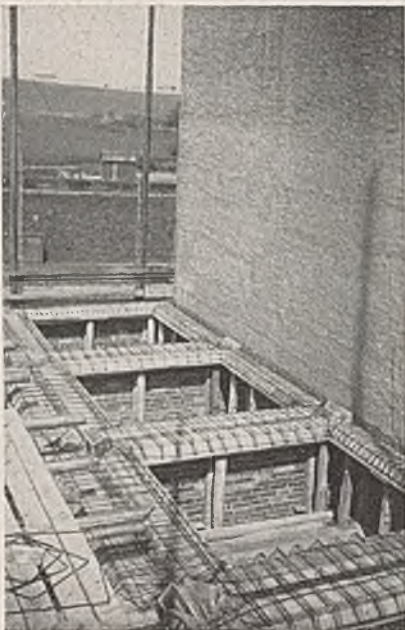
Die Bewehrung der Eisenbetonlüftungsrippen.
